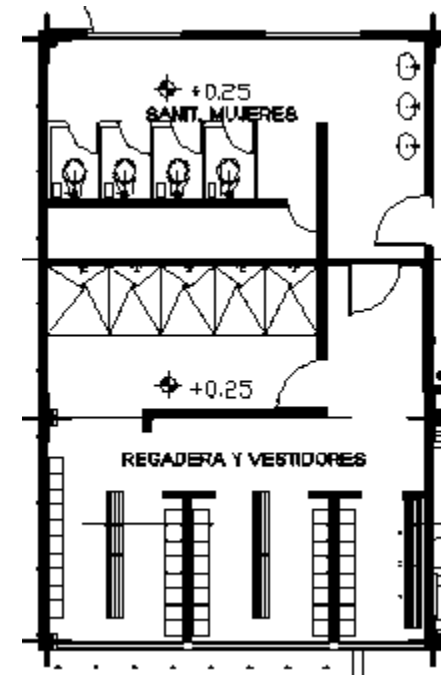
area de estudio. Fuente: Plano arquitectónico del proyecto
